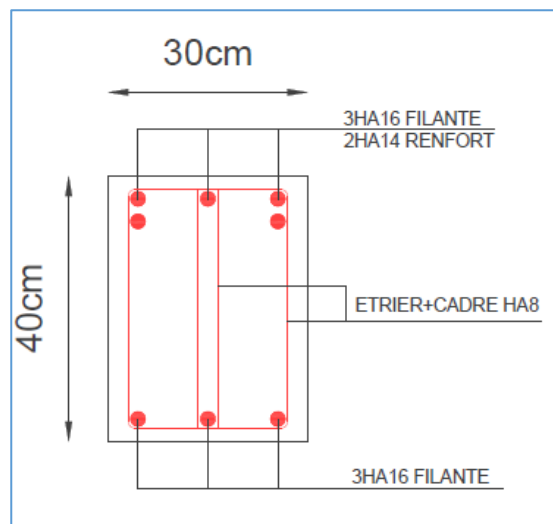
Ferrailage des poutres secondaires sur appui.
